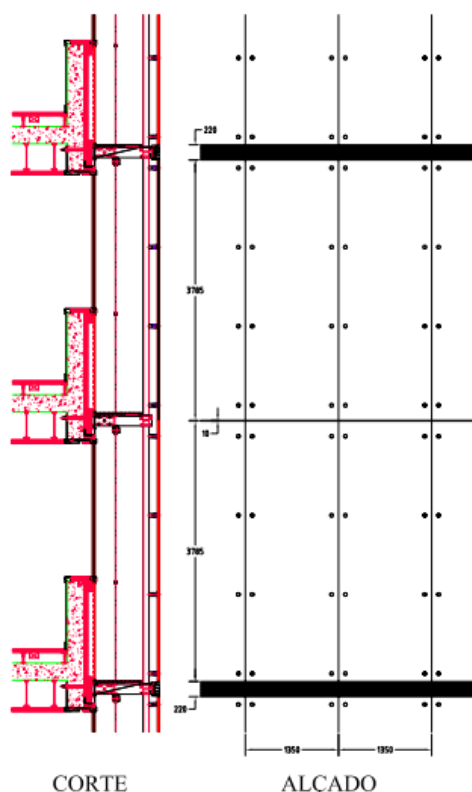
Vista esquemática da fachada de dupla pele (FACAL 2006).
